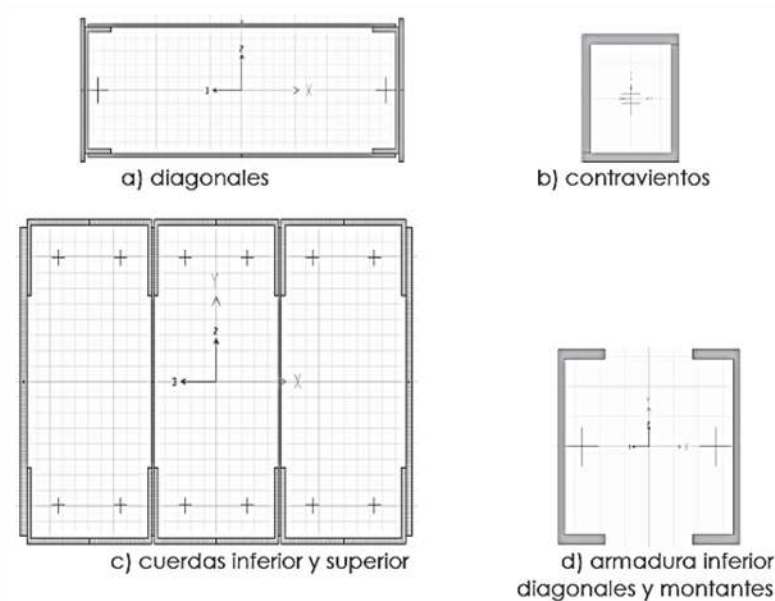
Elementos generales que componen las armaduras metálicas.
